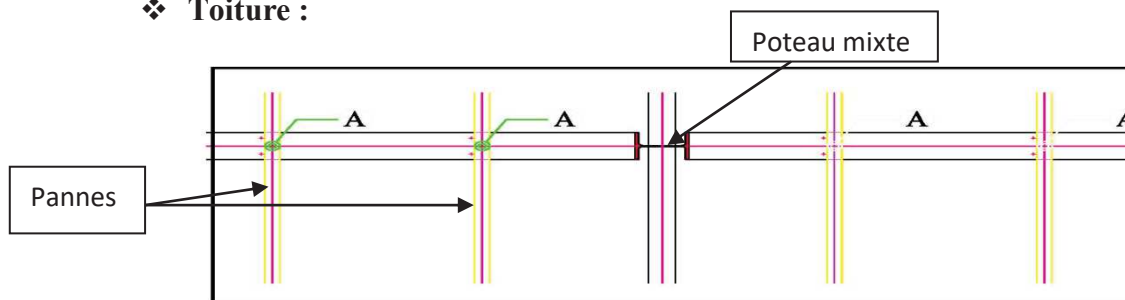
l'effort sollicité sur poteau par les pannes et traverse et la poutre
